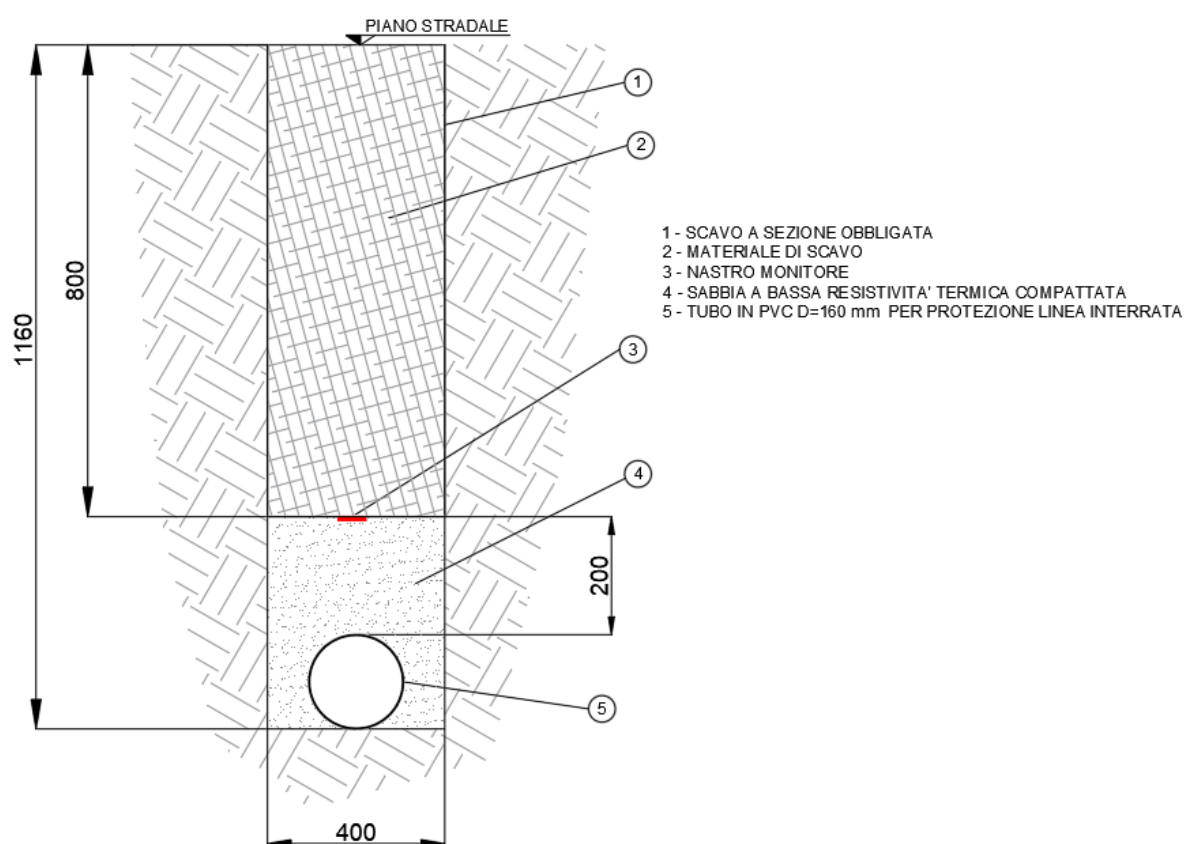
Tipico posa cavidotto interrato MT con protezione meccanica in PVC
